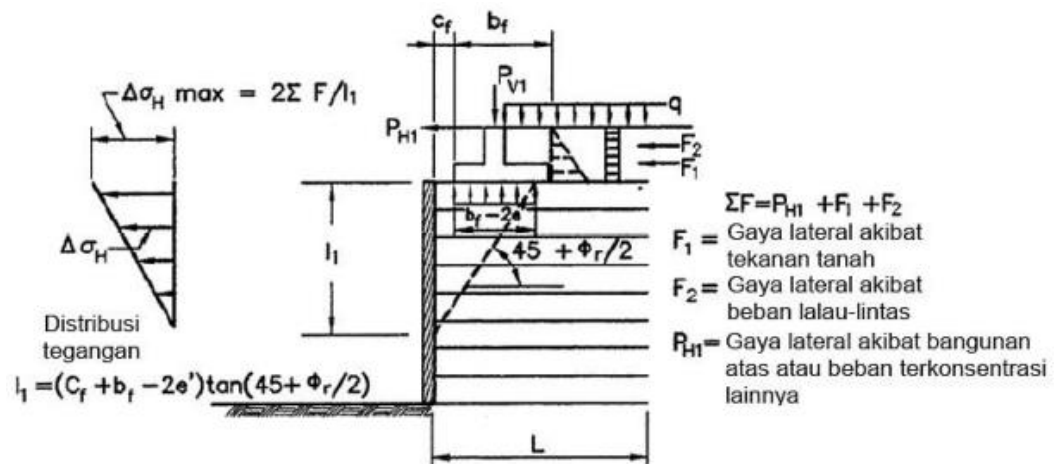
16 - Perhitungan stabilitas internal dan eksternal dengan mempertimbangkan penyebaran tegangan akibat beban vertikal terpusat
